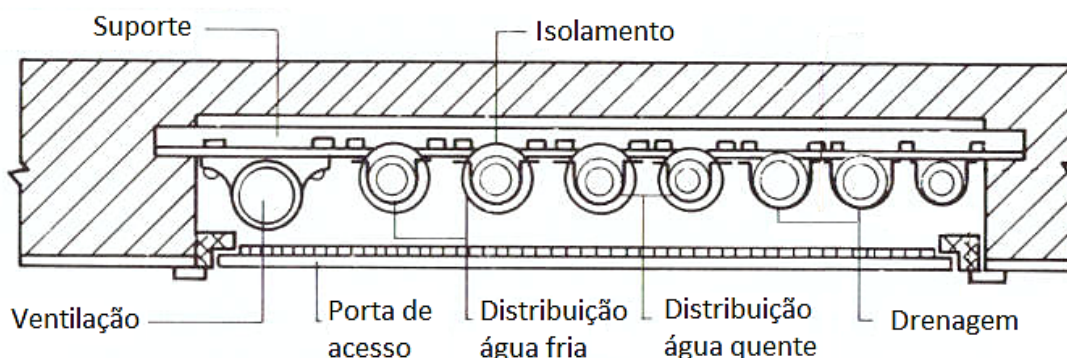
Coluna vertical, ou corete, embutida (em planta). [5]
